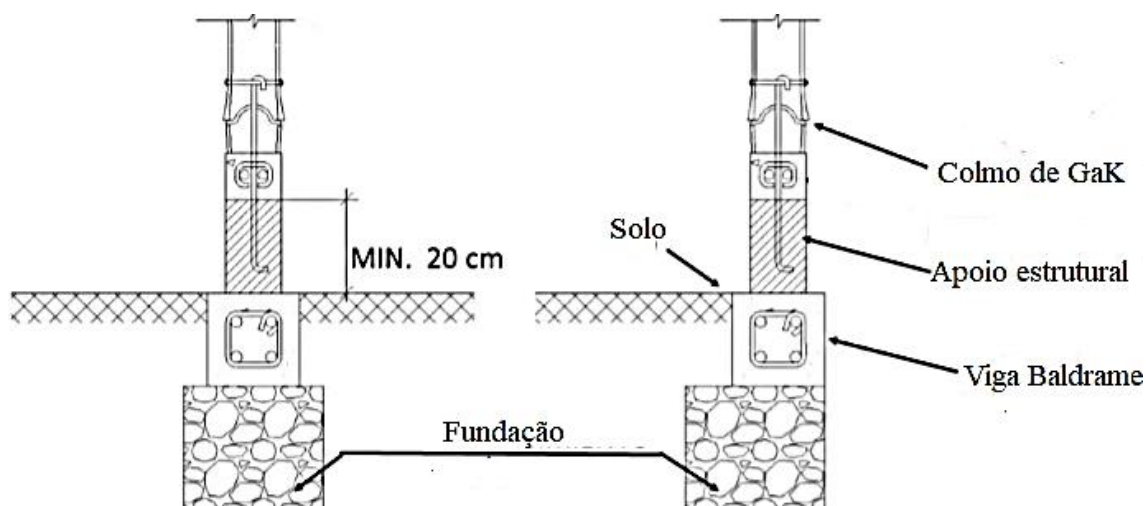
Proteção das guaduas por elevação de apoio do solo. Fonte: Norma Equatoriana (2017) adaptada.
